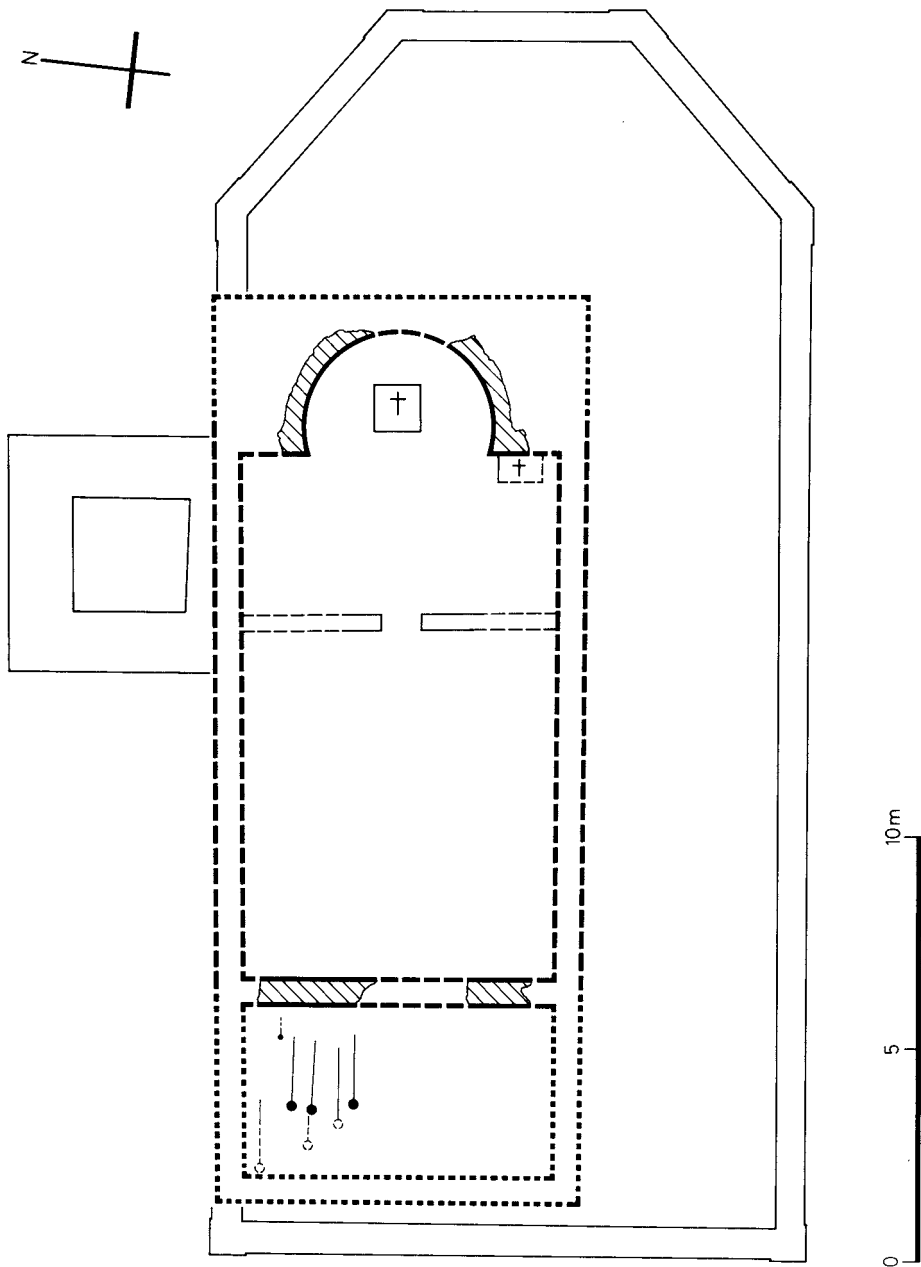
Rekonstruierter Grundriss der Anlage I.
